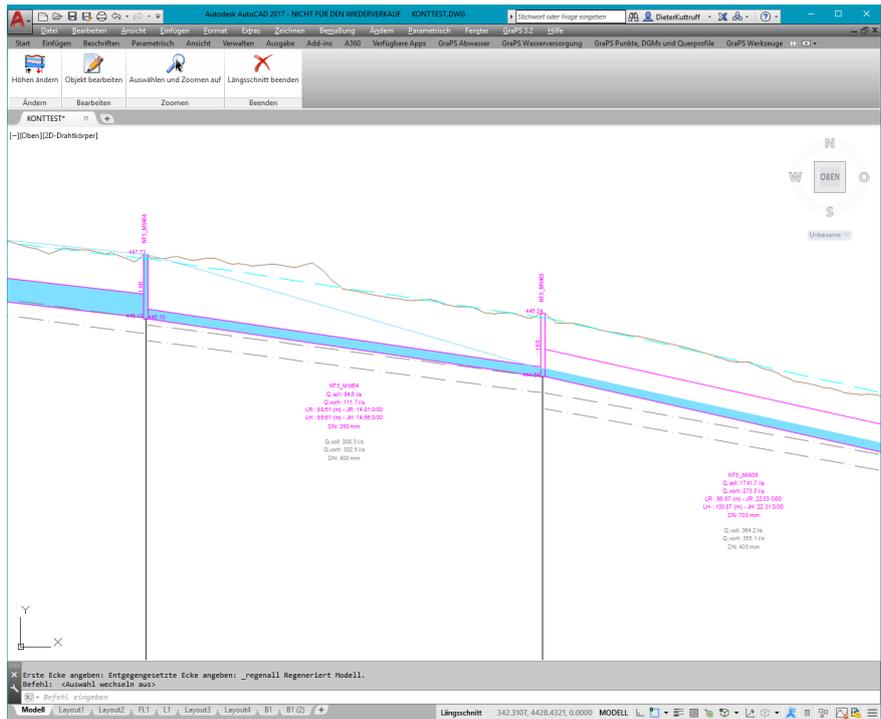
(Konstruktions-) Längsschnitt mit eingezeichneter Variante
